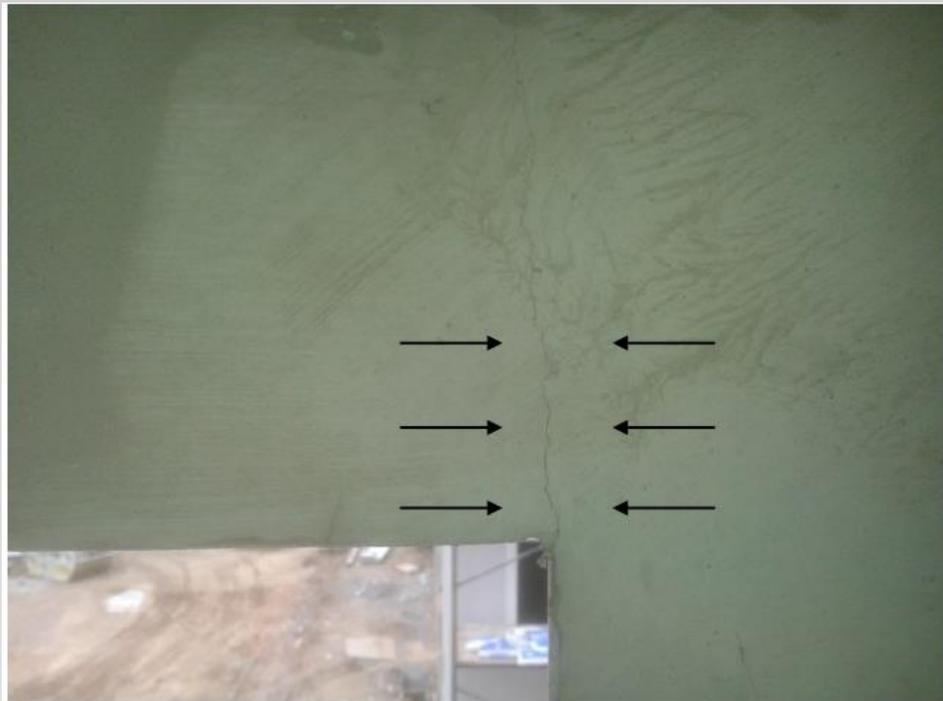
Fissura 90°: Fissuras a 90° de aberturas de portas e janelas
